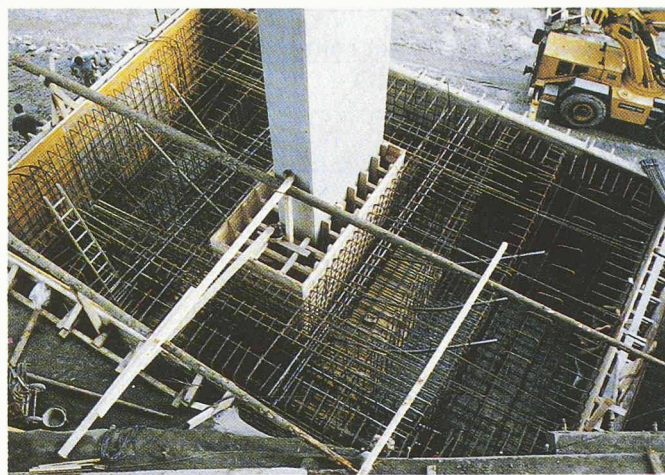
Semelle sur pieux de la pile J. Armature et précontrainte. (Photo A. von Glutz.)
